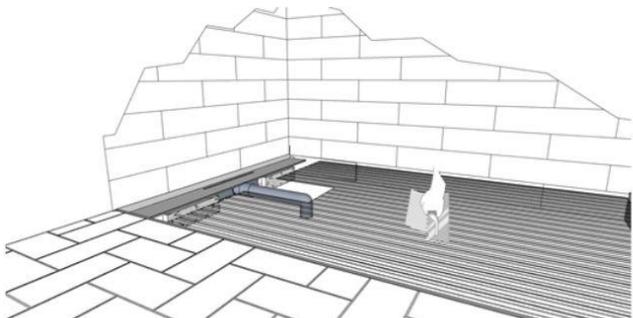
Amaestrar la zona de instalación dejando el espacio necesario para la colocación de las piezas que formarán el plato.
